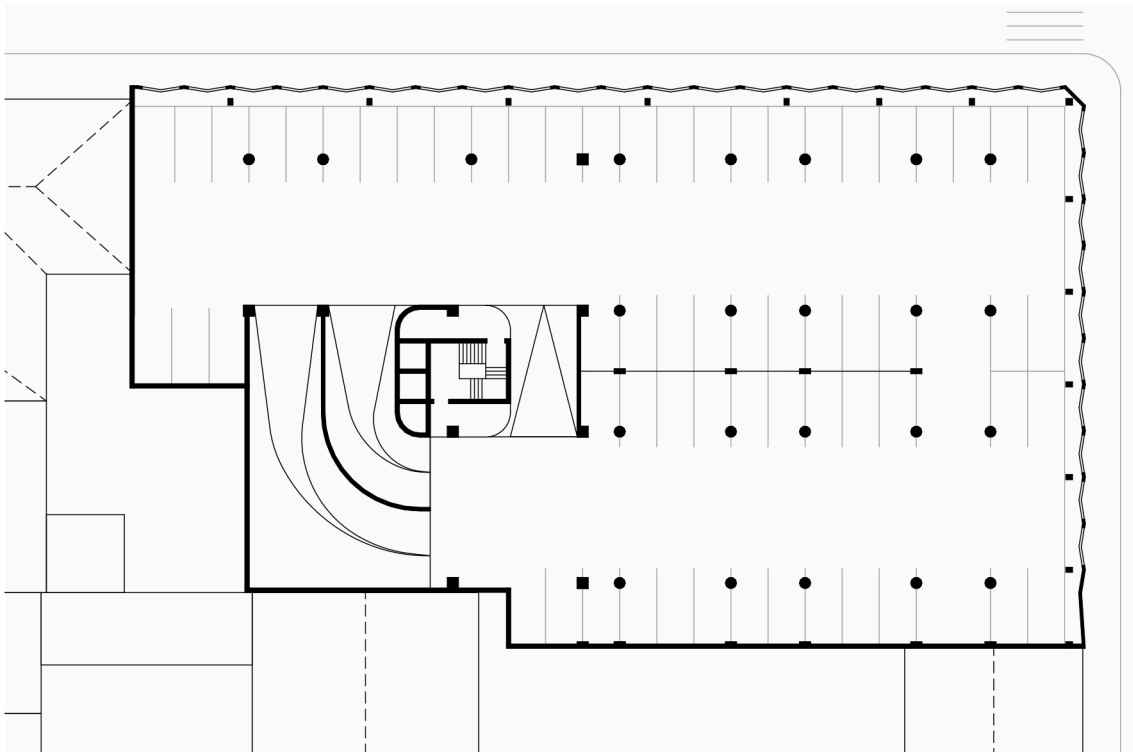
Grundriss 1. Obergeschoss Bestand M 1:500, eigene Darstellung
